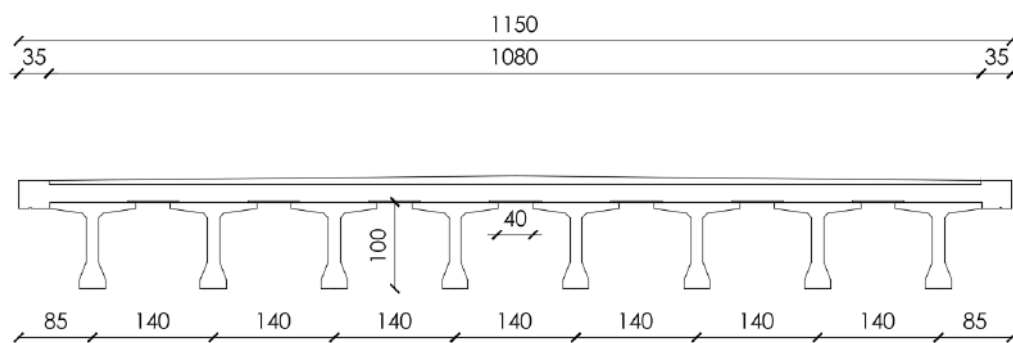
L'IMPALCATO - SEZIONE TRASVERSALE
